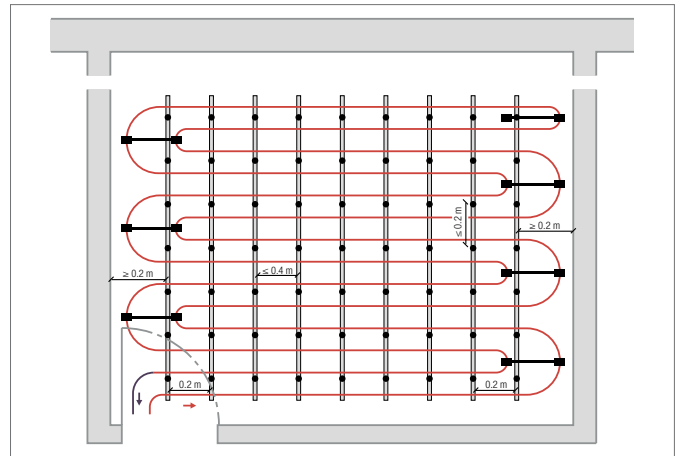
Disposición con ranura doble, paso 5 cm (vista desde arriba sobre el pavimento)
